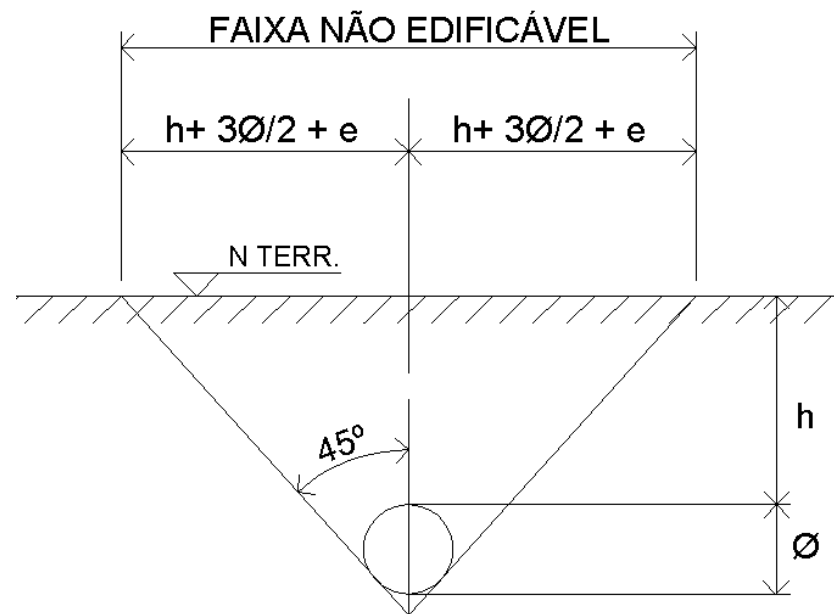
Faixa não-edificável gerada por canalizações pluviais de seção circular.
